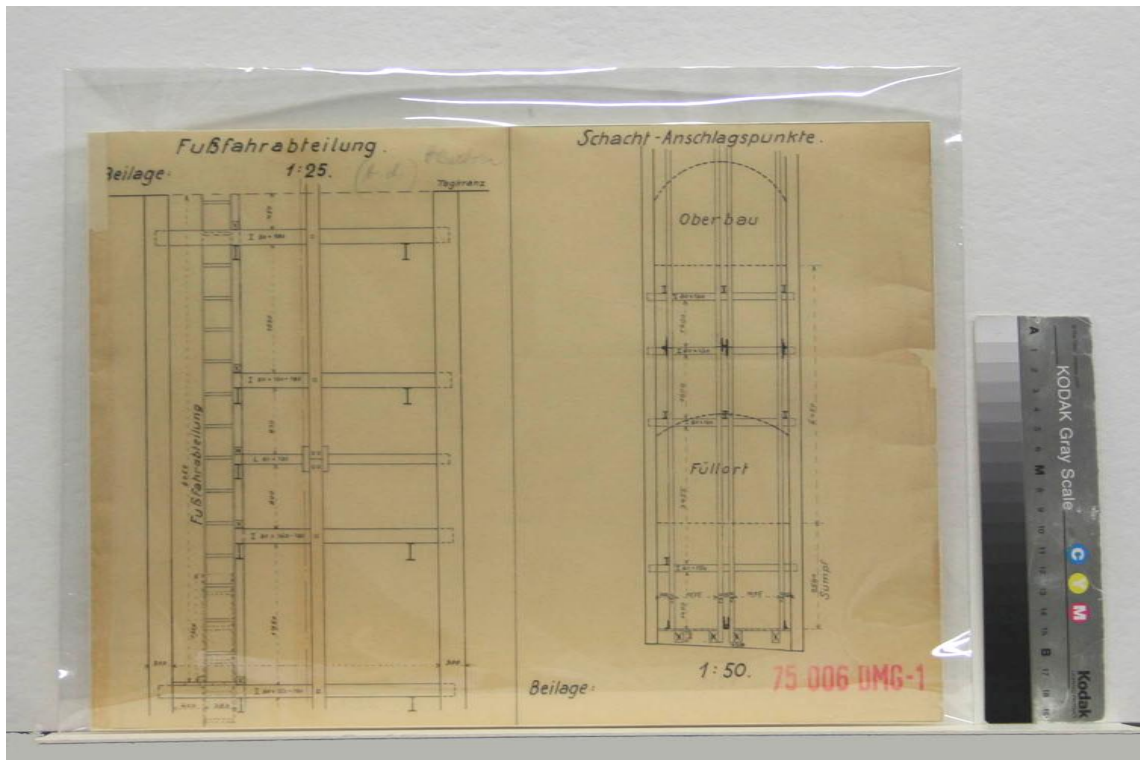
Stav po restaurování, detail chybějících míst po podlepení a doplnění.
